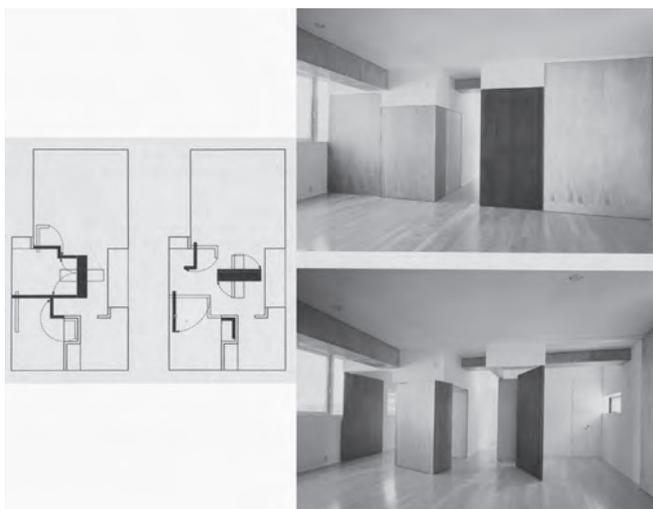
Esquema en planta del espacio articulado y vistas interiores. SHA, Matsuo Photo Atelier, 1990 (Holl 2000, 232-233).
